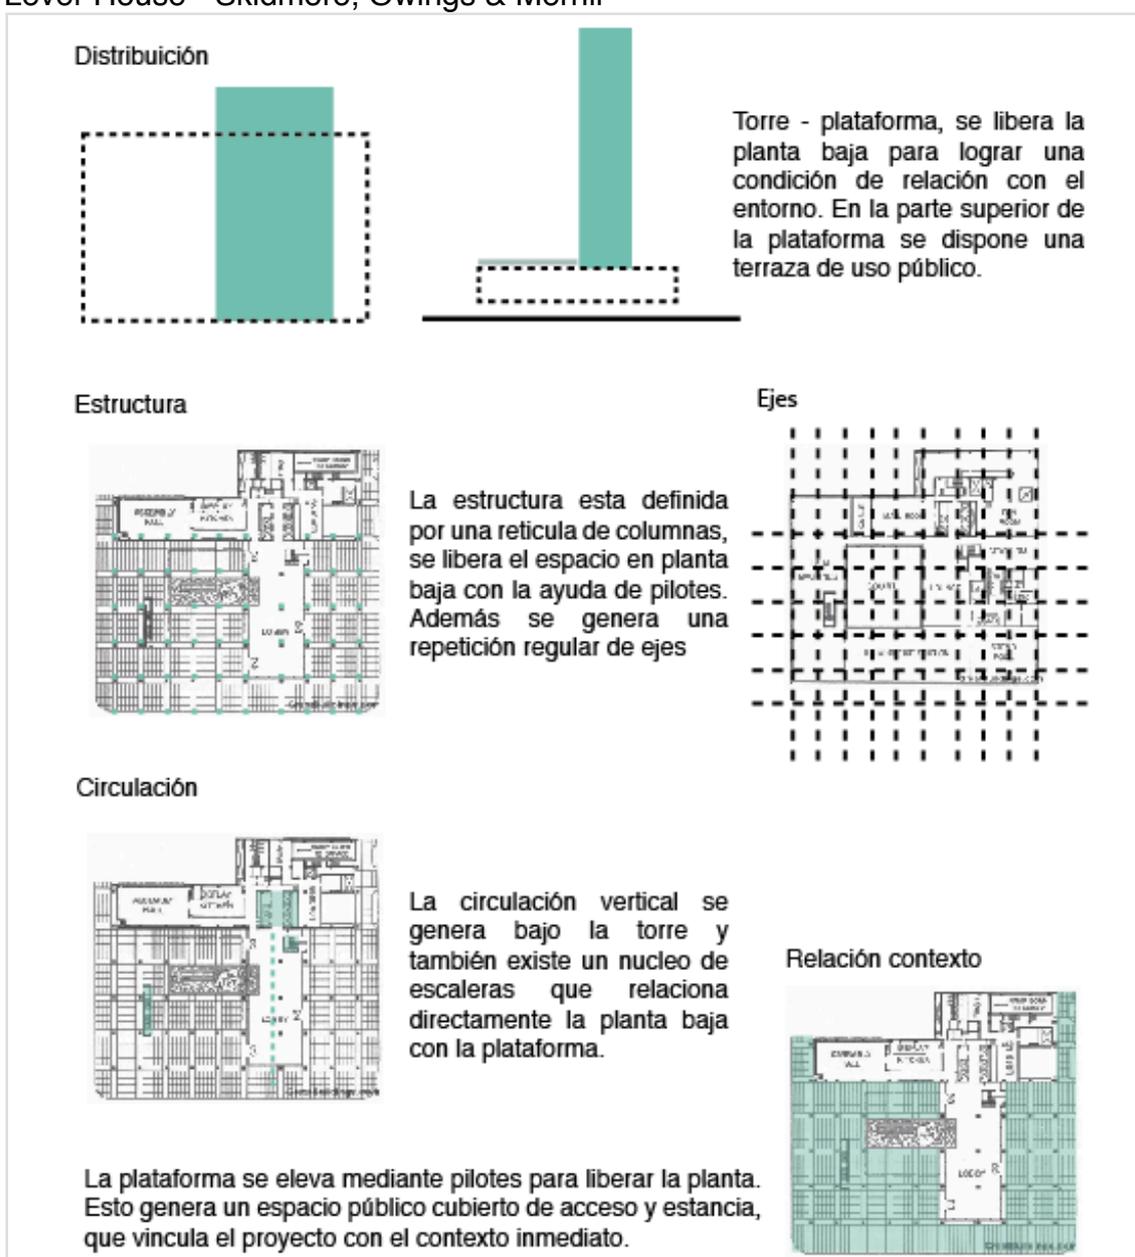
Análisis Lever House. Planos obtenidos de <http://openbuildings.com/buildings/lever-house-profile.com>
